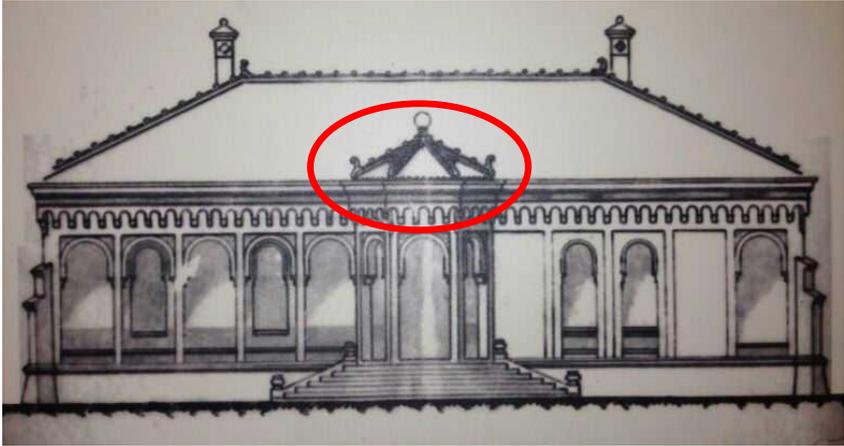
Alzado proyectado (2013) - Exposición ETSIE
